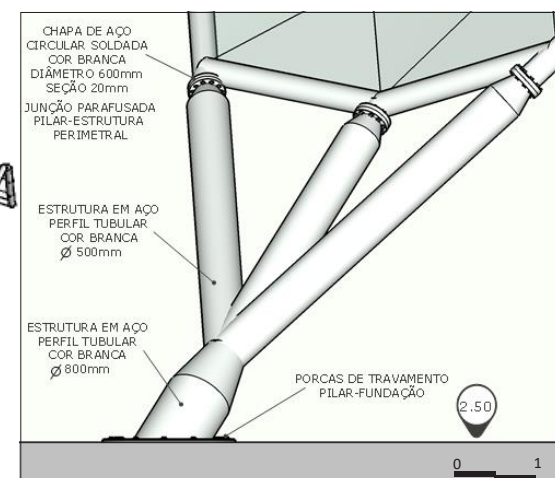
Detalhe pilar árvore P13, elevação sudeste. Elaborado pelo autor, 2018
